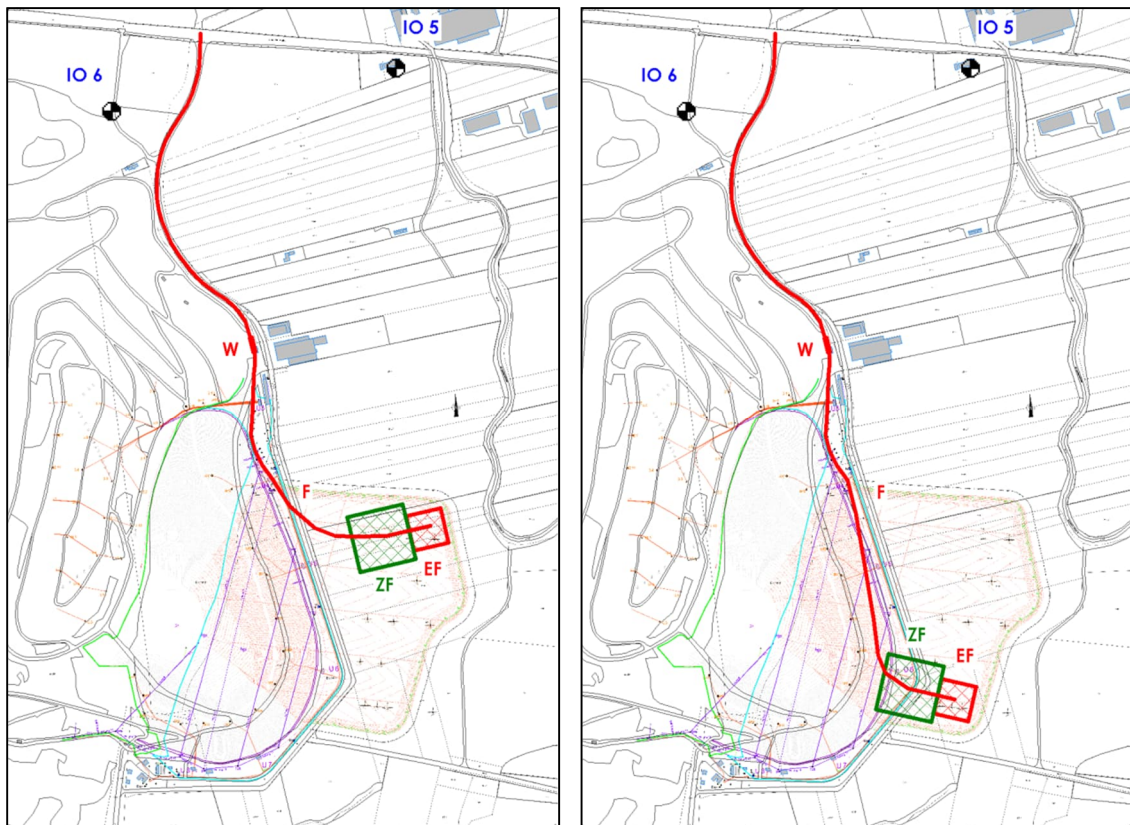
Lageplan /23, 24, 33/ mit Darstellung der relevanten Schallquellen in Bauabschnitt BA V (links) und Bauabschnitt BA VI (rechts)
